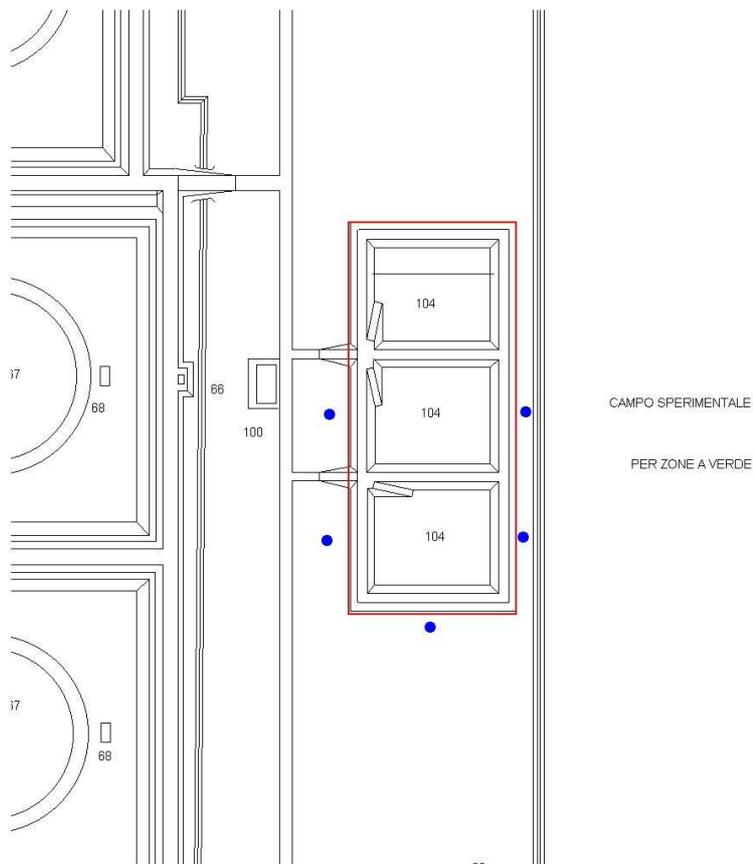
Estratto della planimetria della centrale: vasche ceneri e fanghi;
